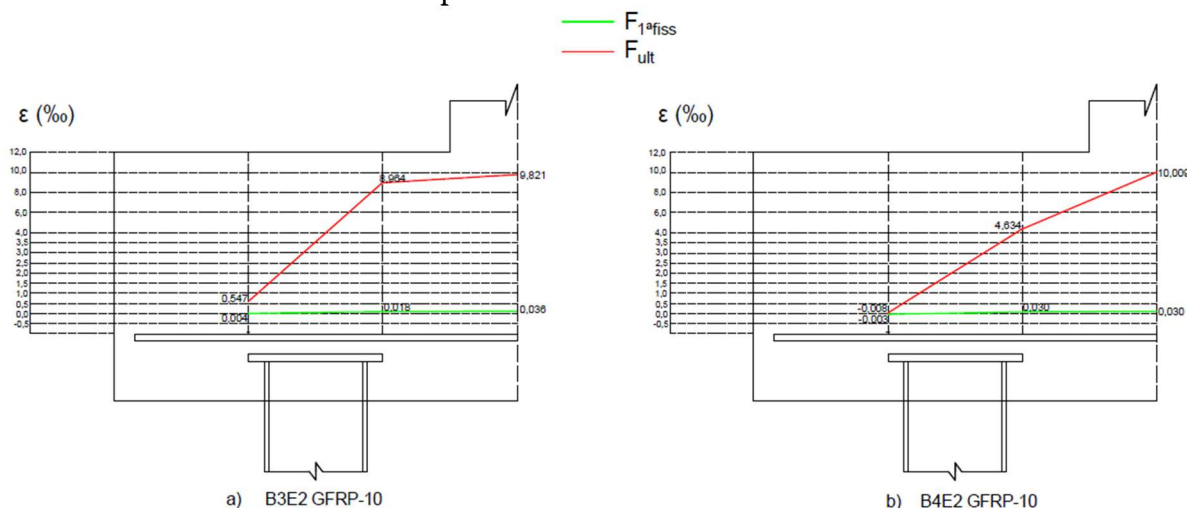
Deformação nas armaduras dos tirantes nos instantes de abertura da 1ª fissura e na ruptura dos blocos do modelo 1
